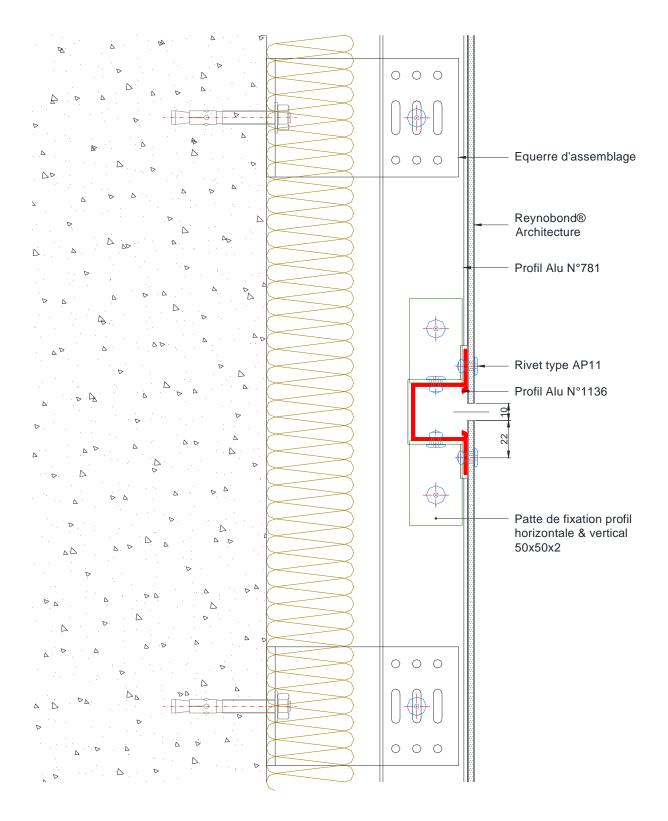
Joint horizontal - Coupe verticale – Système riveté RV 50 4c
